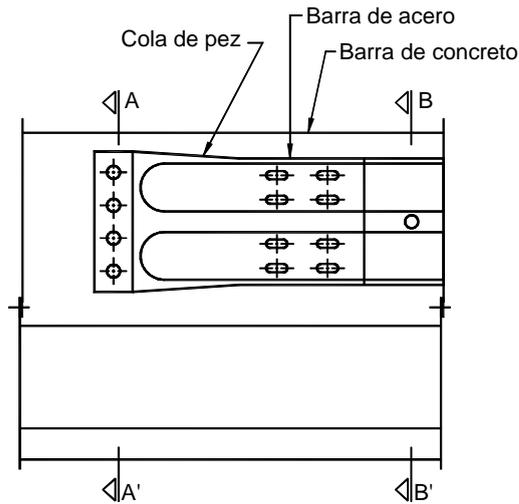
Sistema de fundación y de anclaje de una barrera de seguridad de concreto, según su método de construcción.
